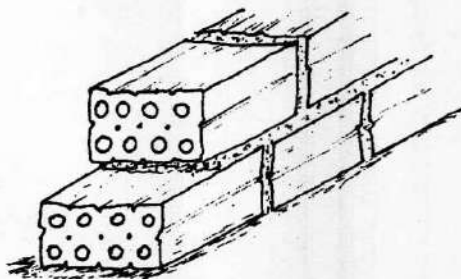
Execução de alvenaria de 1 vez, utilizando tijolos furados.
